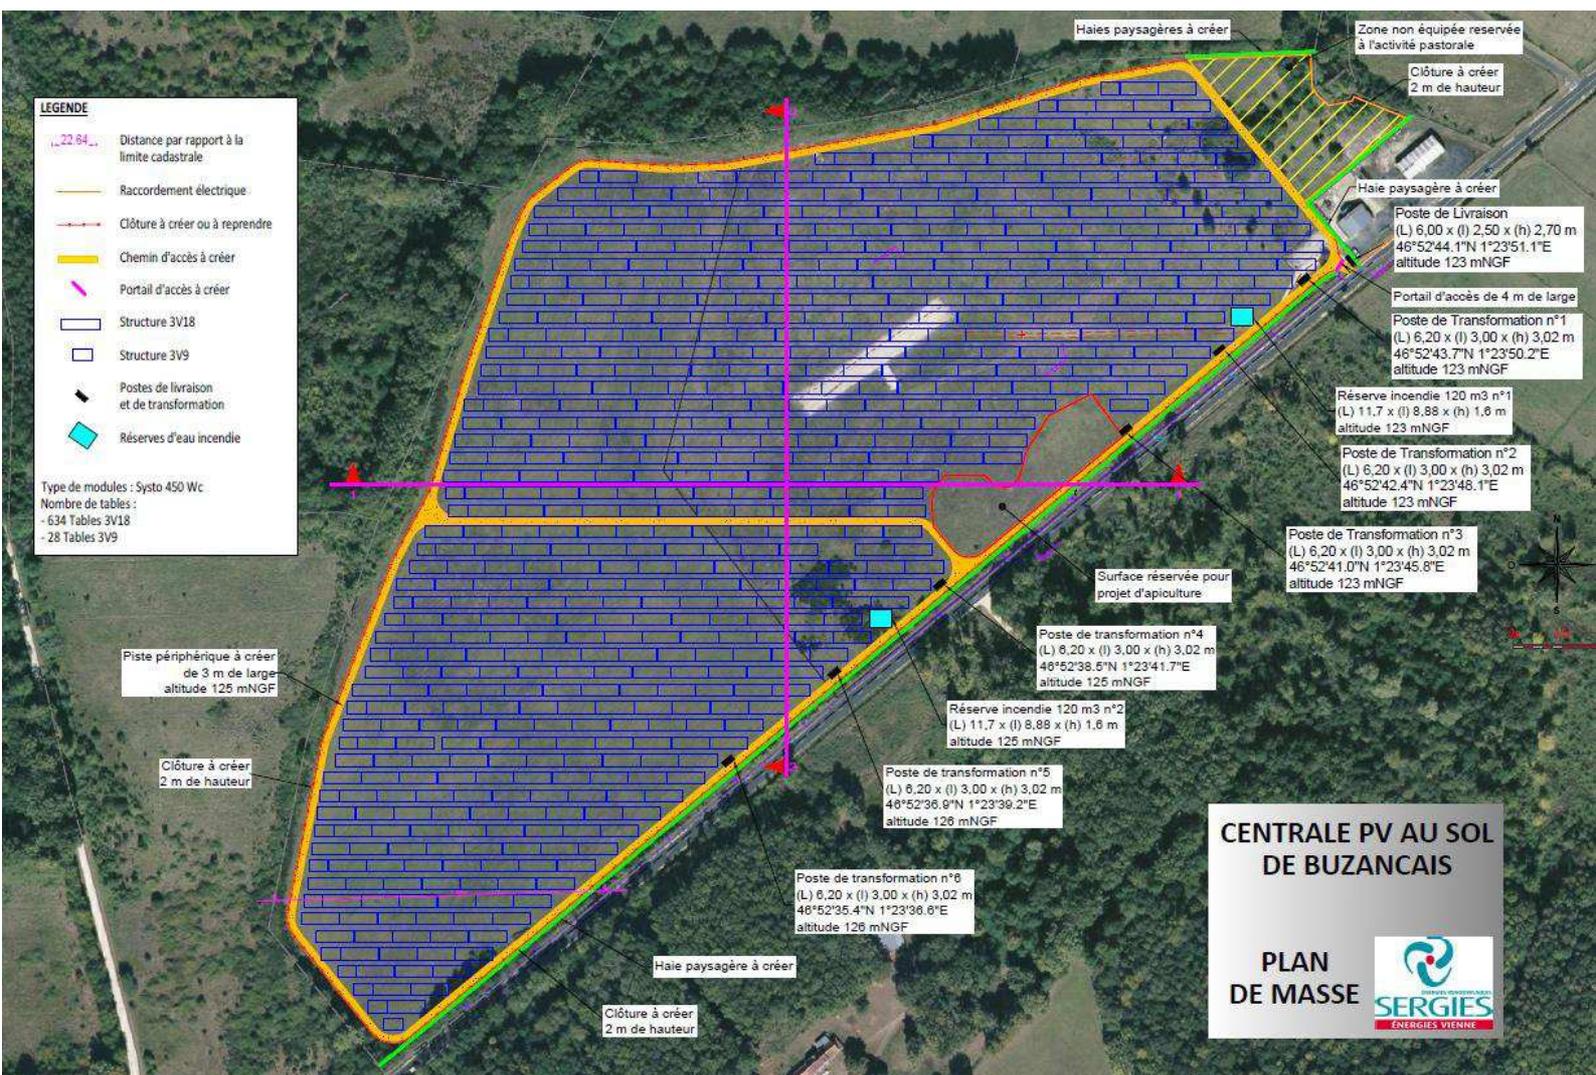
plan de masse de l'installation (Source : étude d'impact, page 89)
